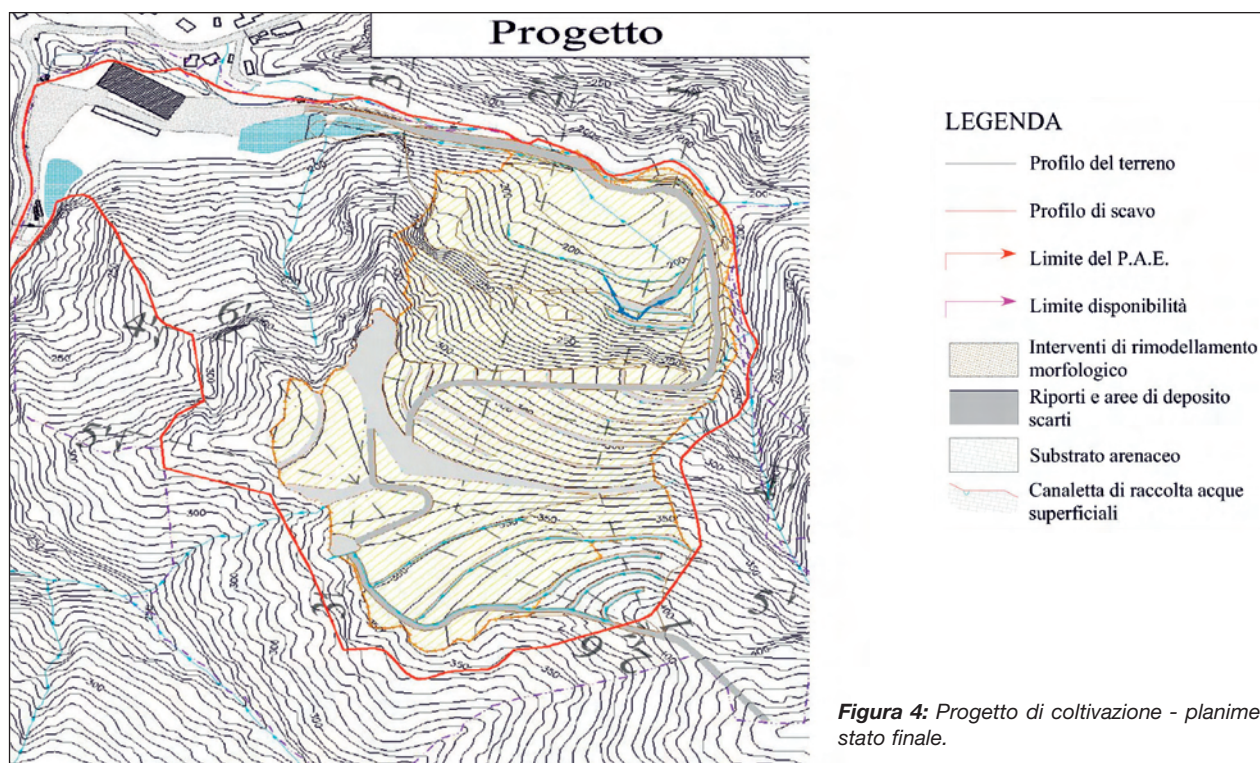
Progetto di coltivazione - planimetria dello stato finale.
